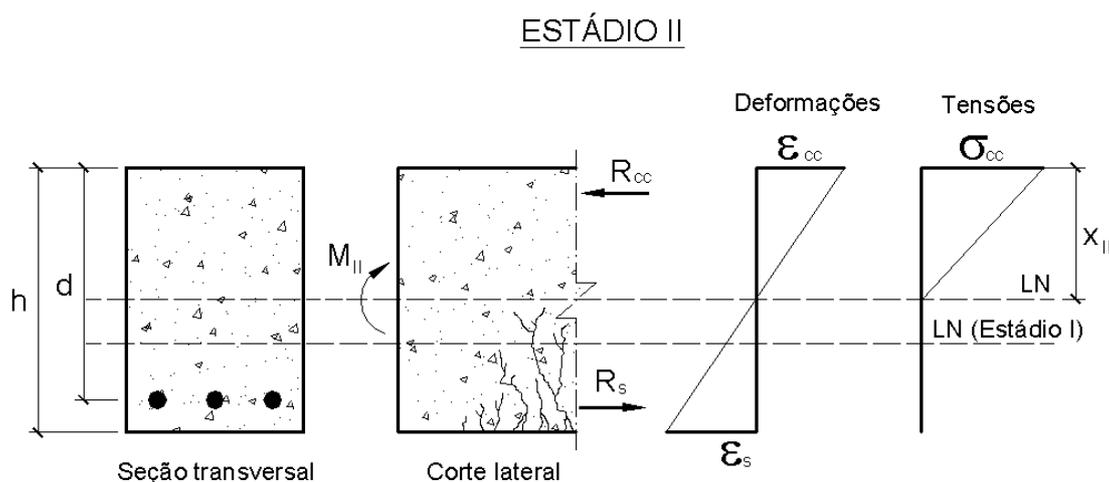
Comportamento do concreto na flexão pura (Estádio II)
